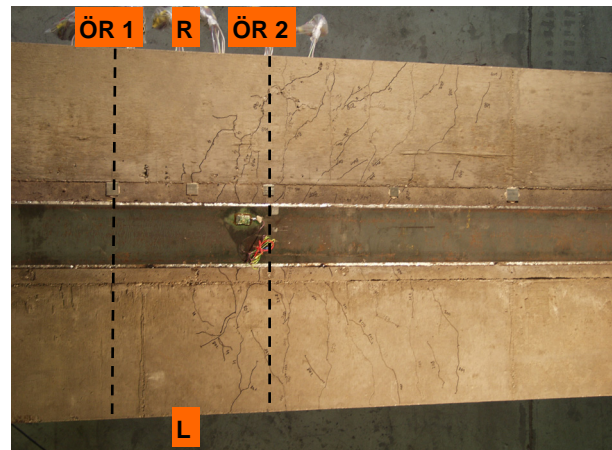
Rissbild auf der Betongurtunterseite
